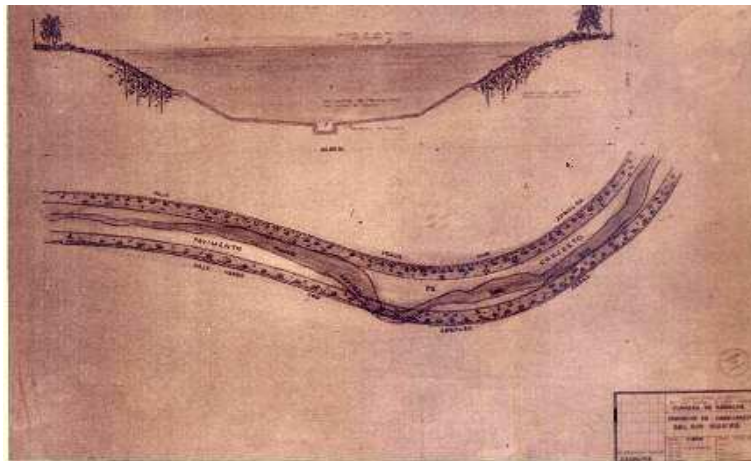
Corte transversal del río Guaire y detalle del proyecto de canalización. Detalle de la canalización y modificación artificial de un tramo de río Guaire, año 1949 (fuente: revista ELITE. N° 1195. 28 de agosto de 1948) consultado en Nava, M. (2009).
